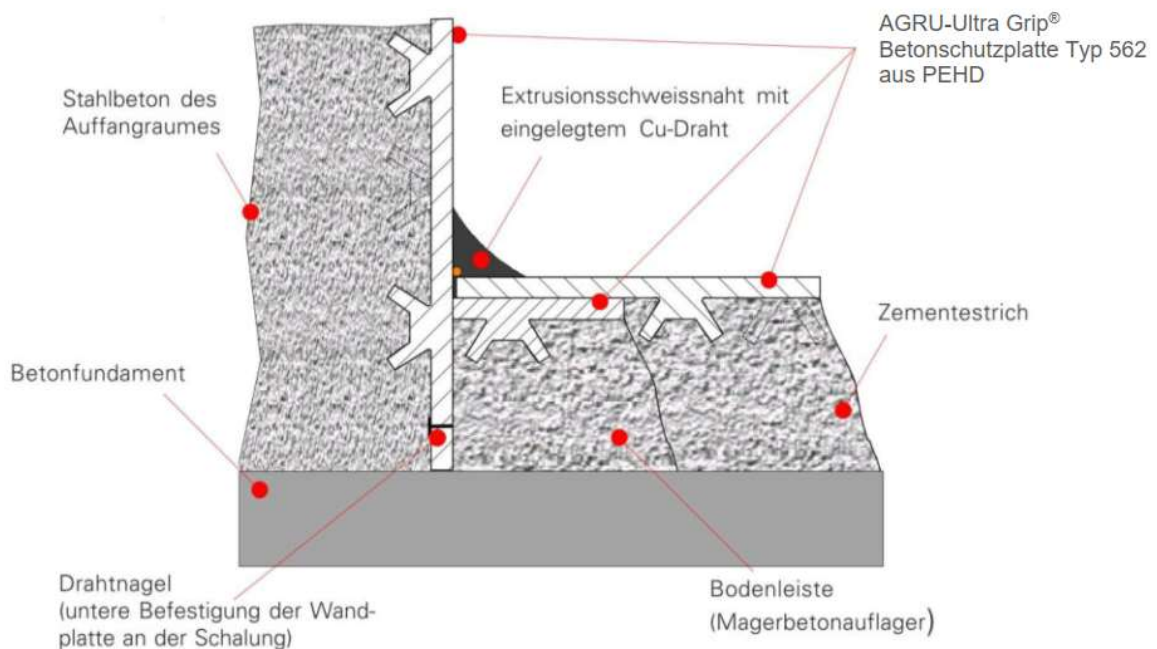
Plattenverbindung mit Magerbetonauflagern- Einbausituation (AGRU)
